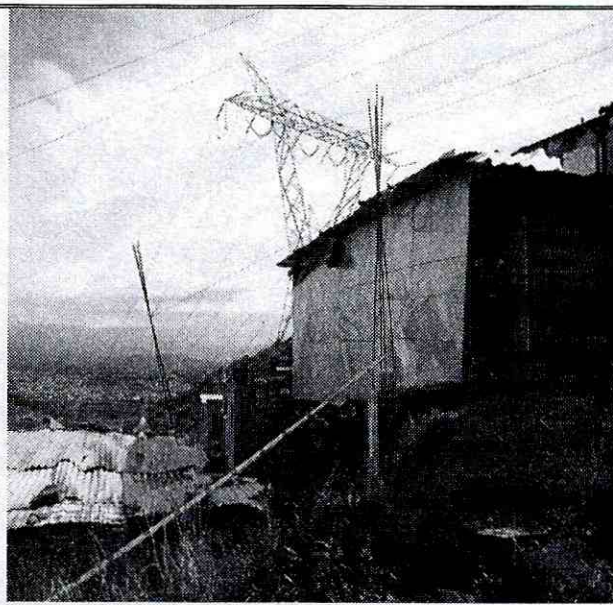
Se observa la vivienda de la Calle 78 C Sur No. 14-26 afectada por el impacto del muro de cerramiento.
